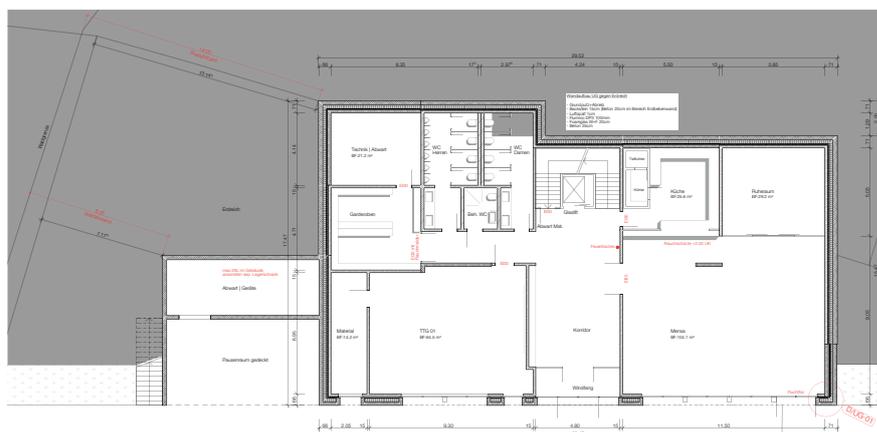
Grundriss Sokelgeschoss mit Waldabstand
